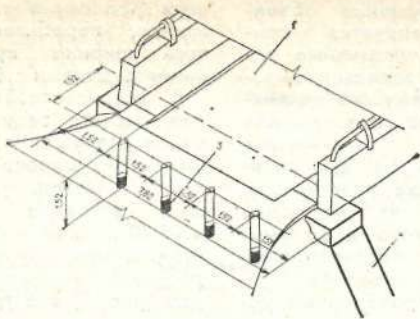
Схема размещения зарядов ВВ при разрушении береговой опоры железобетонного моста: 1 — пролетное строение; 2 — береговая опора; 3 — заряд ВВ (размеры даны в метрах)
